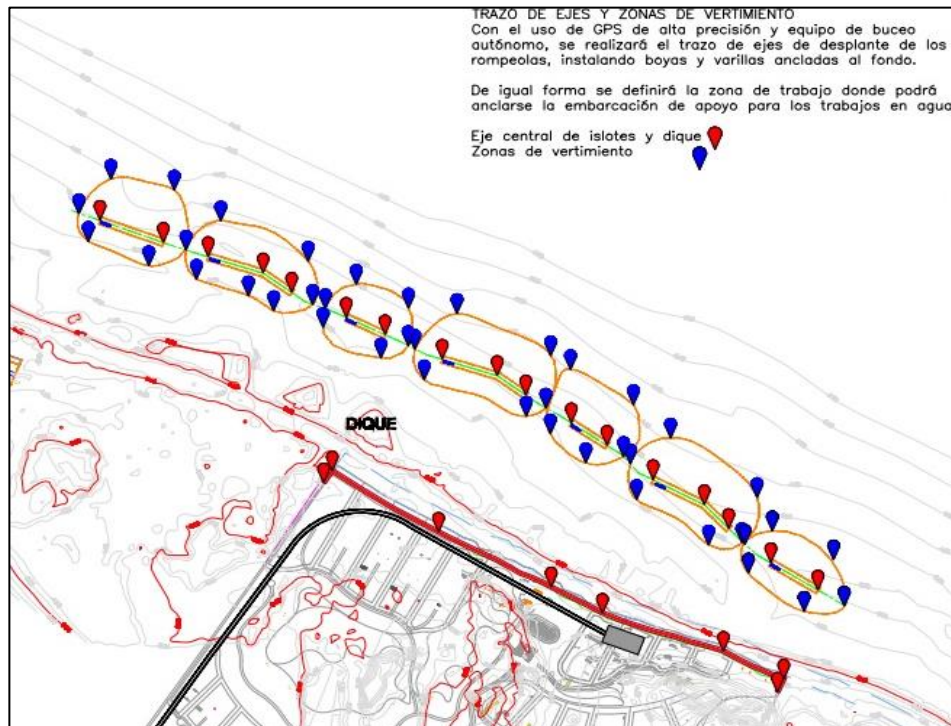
Trazo de estructuras y elementos del proyecto.
